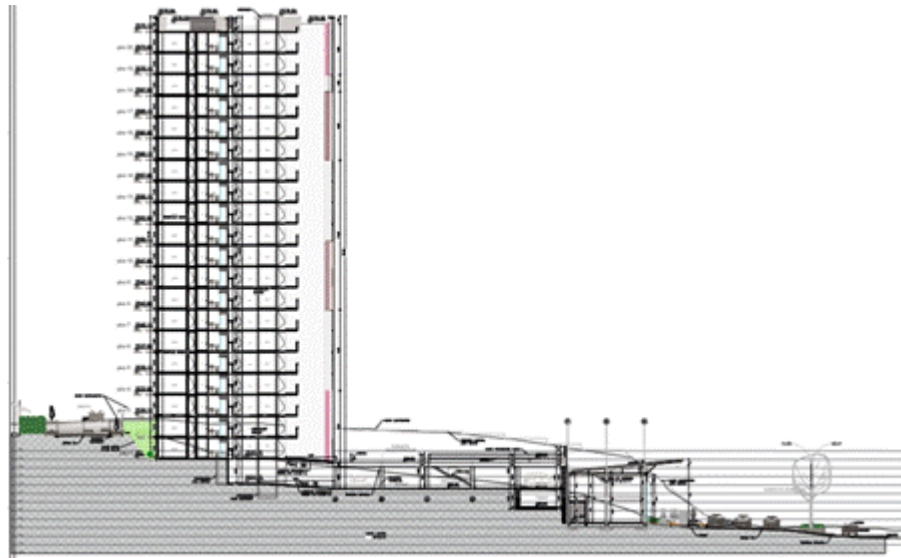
PERFIL DEL EDIFICIO. FUENTE: CONSTRUCTORA
